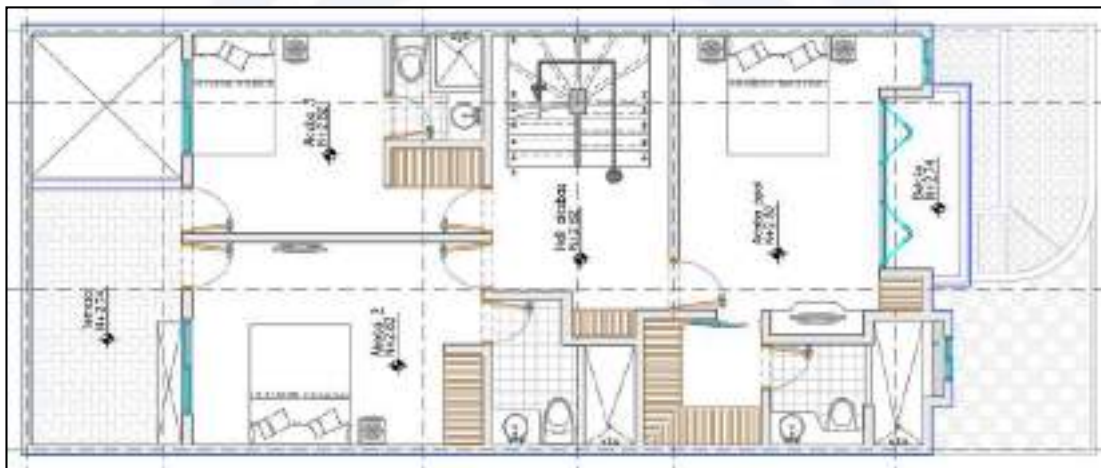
Preliminar Planta arquitectónica Nivel 2
